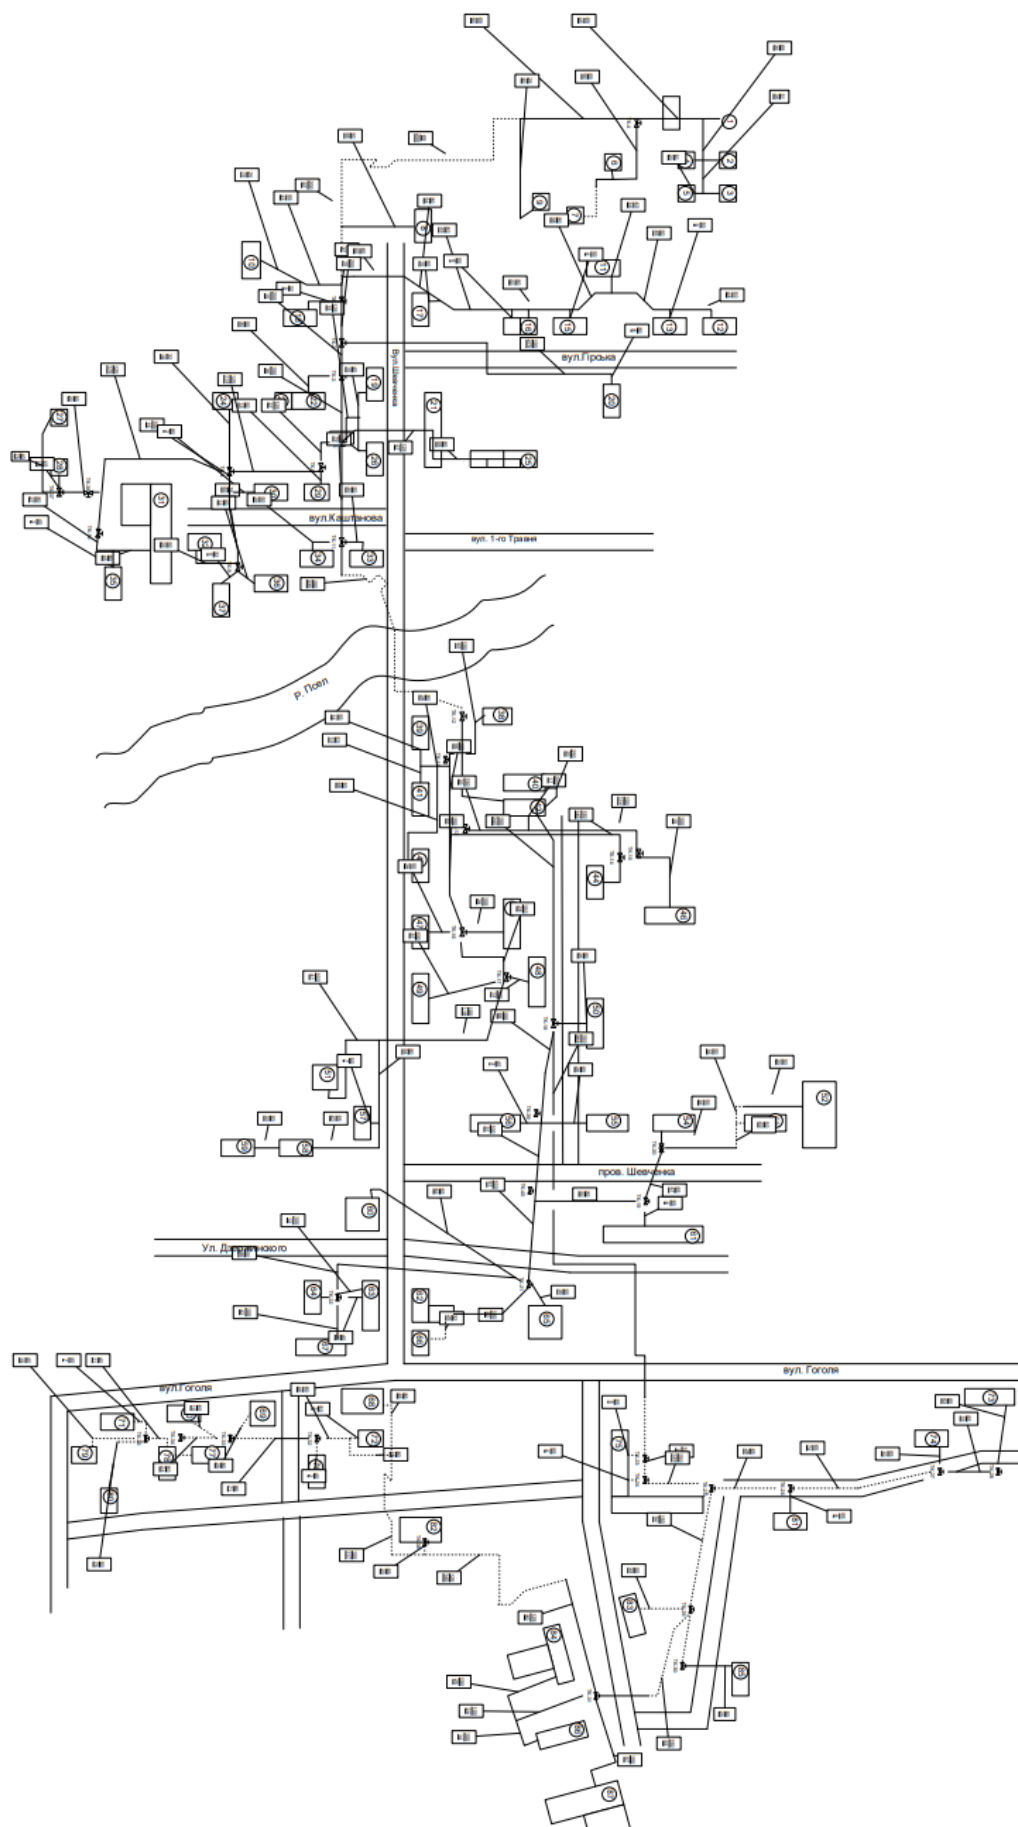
Генеральний план розташування абонентів що обслуговує котельня
